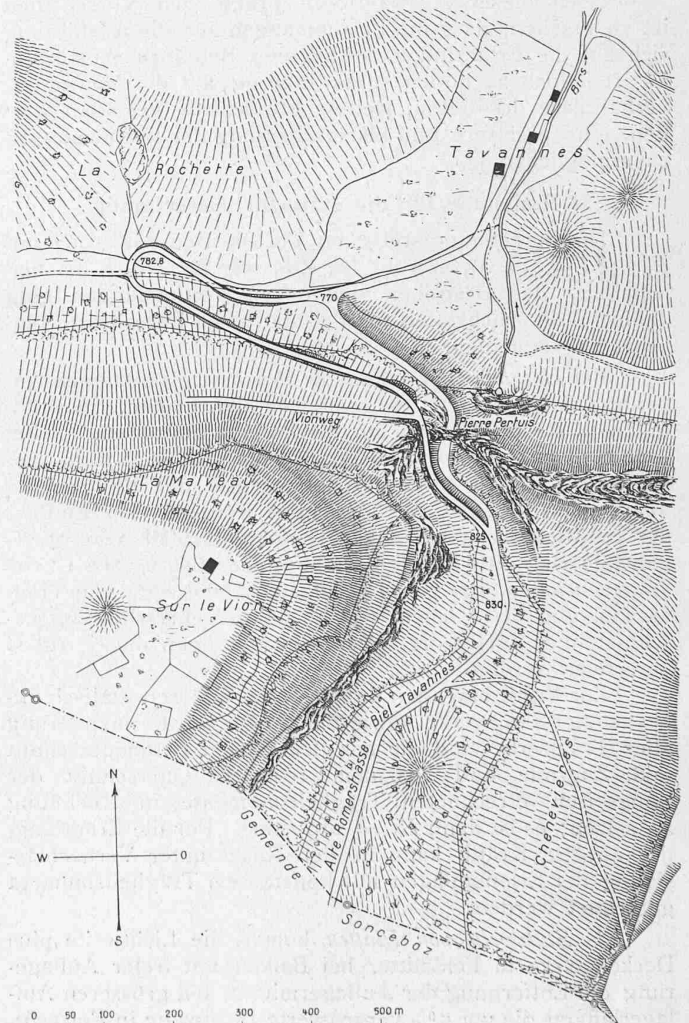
Korrektur der Nordrampe der Pierre-Pertuis-Strasse. — 1 : 10.000.
